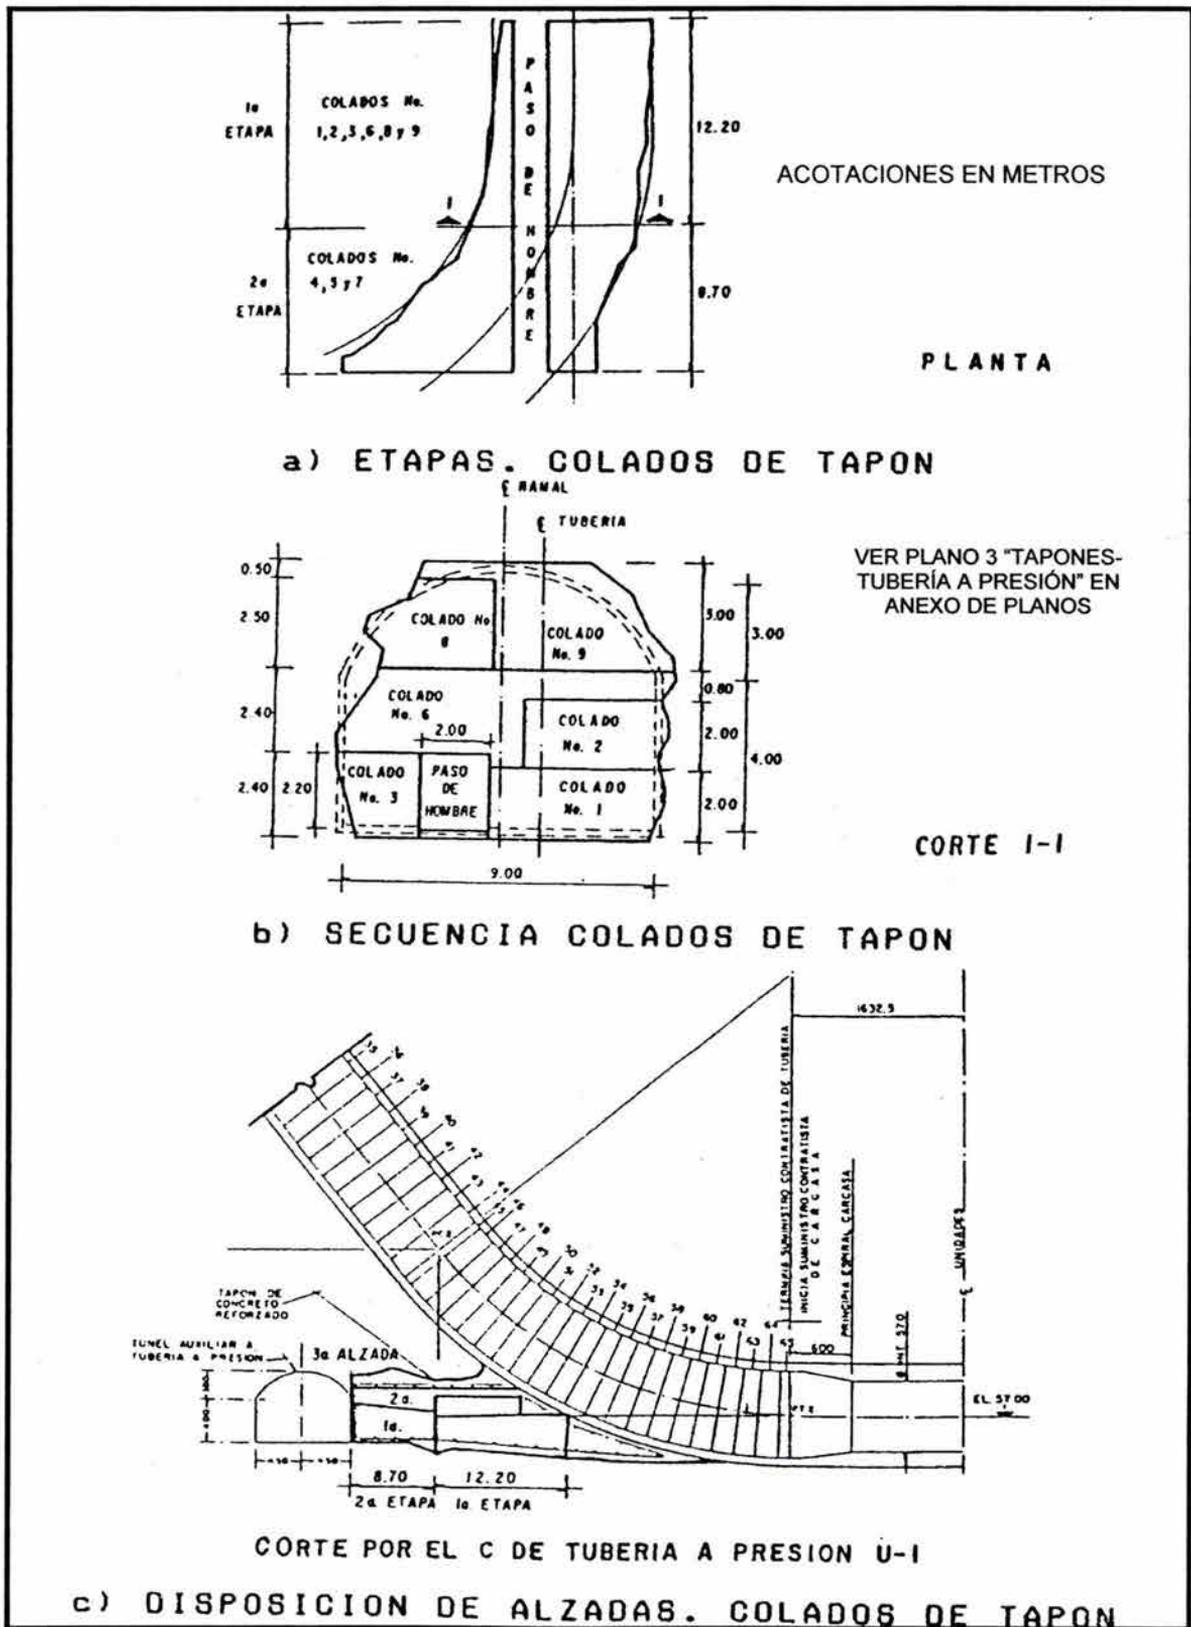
RAMAL INFERIOR, TUBERÍA A PRESIÓN U-3 (Continuación)
